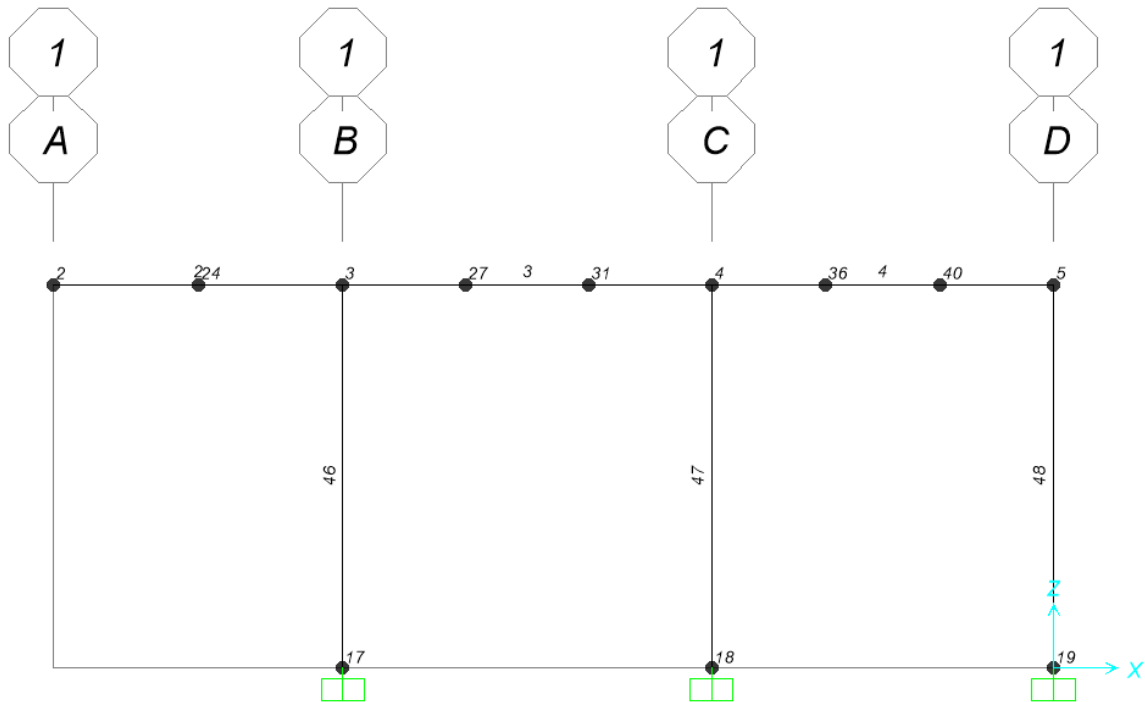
Vista in sezione modello struttura in elevazione –Filo 1 - numerazione elementi frame e joint
